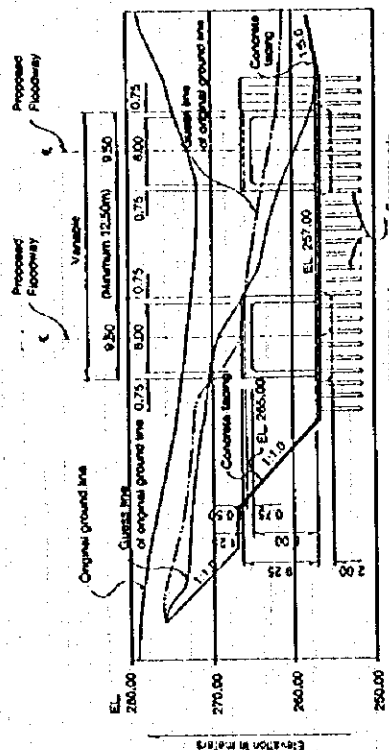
チリクワン放水路吐口計画平面・縦横断面図
